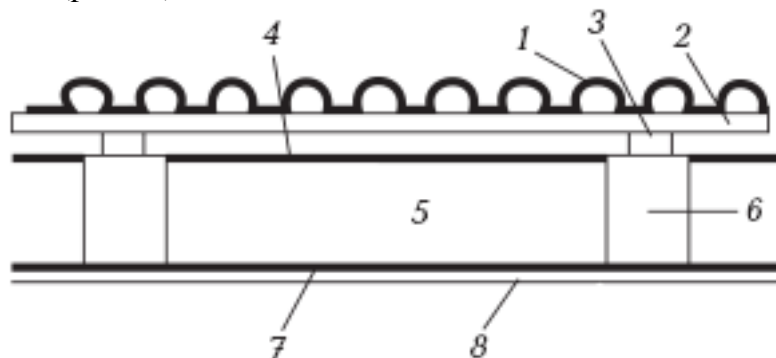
Утепление крыши с укладкой теплоизоляции между стропилами: 1 – кровельное покрытие; 2 – обрешетка; 3 – брусок; 4 – ветро-, влагозащитная мембрана; 5 – утеплитель; 6 – стропила; 7 – гидроизоляция; 8 – обрешетка
